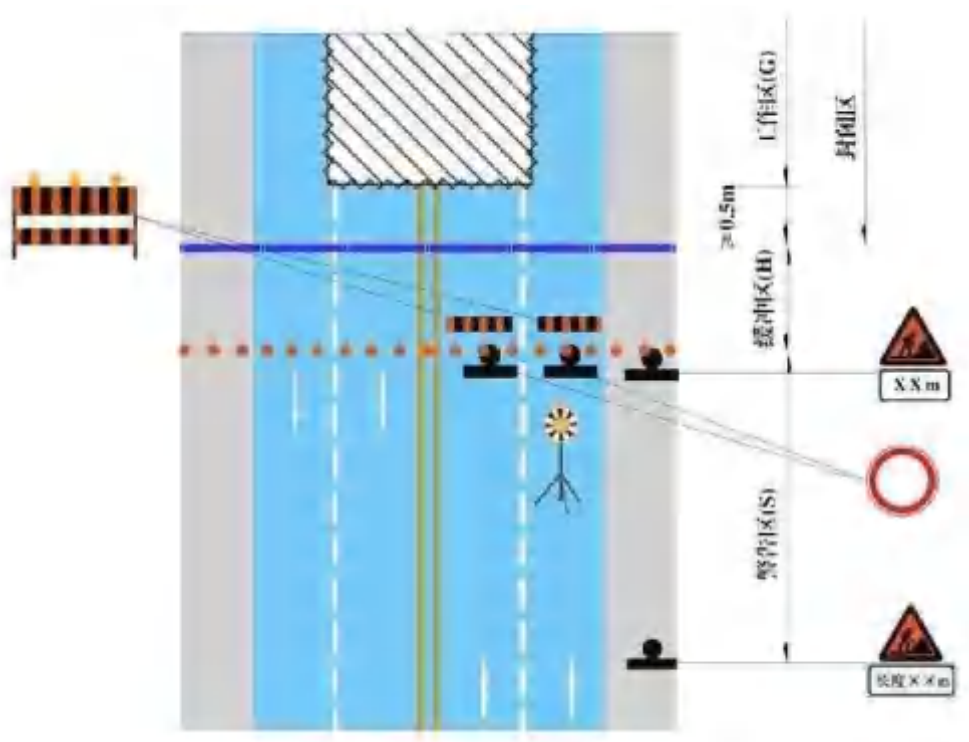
缓冲区 H 大于 30 m 作业区设置示意图
